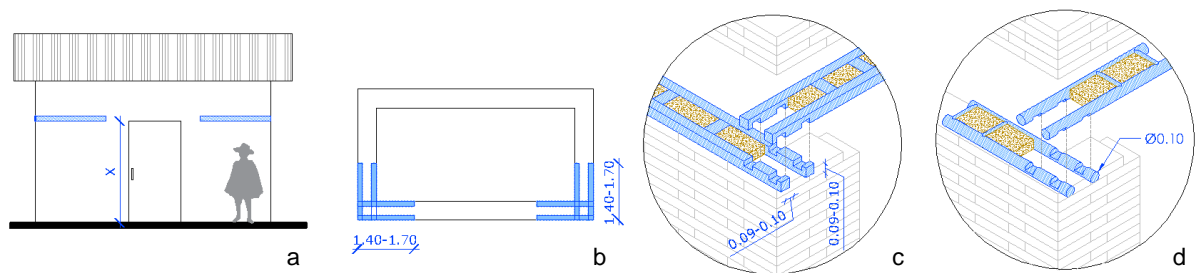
a) Dispositivo DC instalado a la altura del dintel. b) Dimensiones de dispositivos en planta c) Detalle de dispositivo sección rectangular d) Detalle de dispositivo sección circular.
